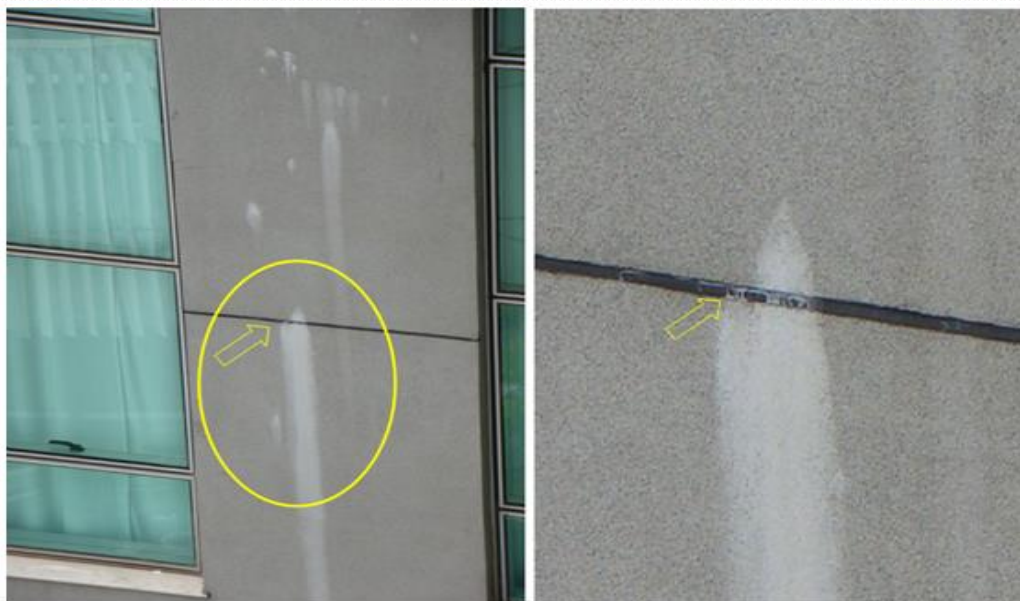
/10/2011: fachada do BLOCO A com trecho lateral ainda com pouca eflorescência, mas as contínuas infiltrações pelos rejuntos desgastados e não substituídos, causam fissuras devido ao desprendimento do revestimento
